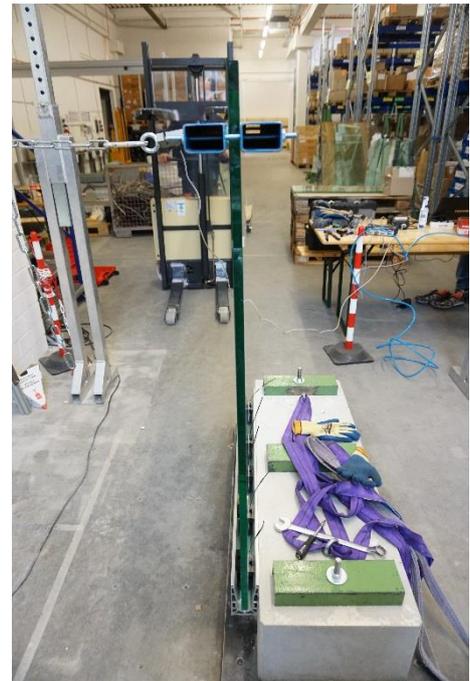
Configuración de prueba VetroMount Side (montaje frontal)
